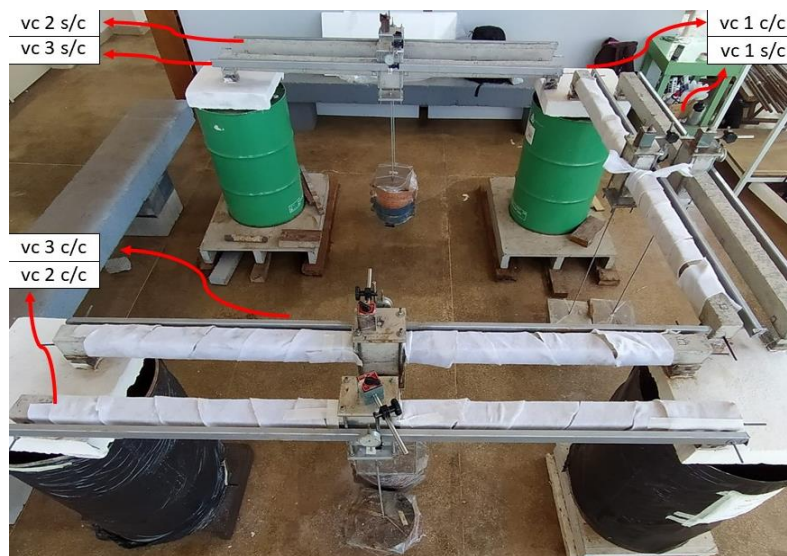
Arranjo das vigas durante o ensaio de longa duração.
